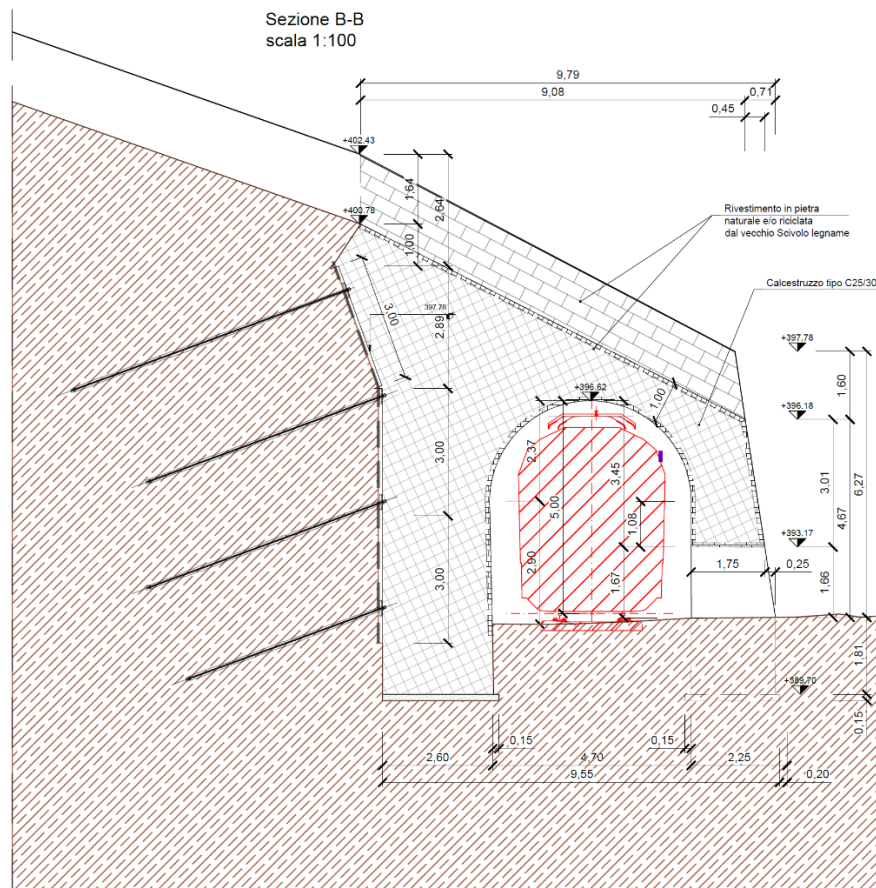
IV02 - Scivolo legname 134+610 – Realizzazione nuovo manufatto, sezione trasversale B-B
